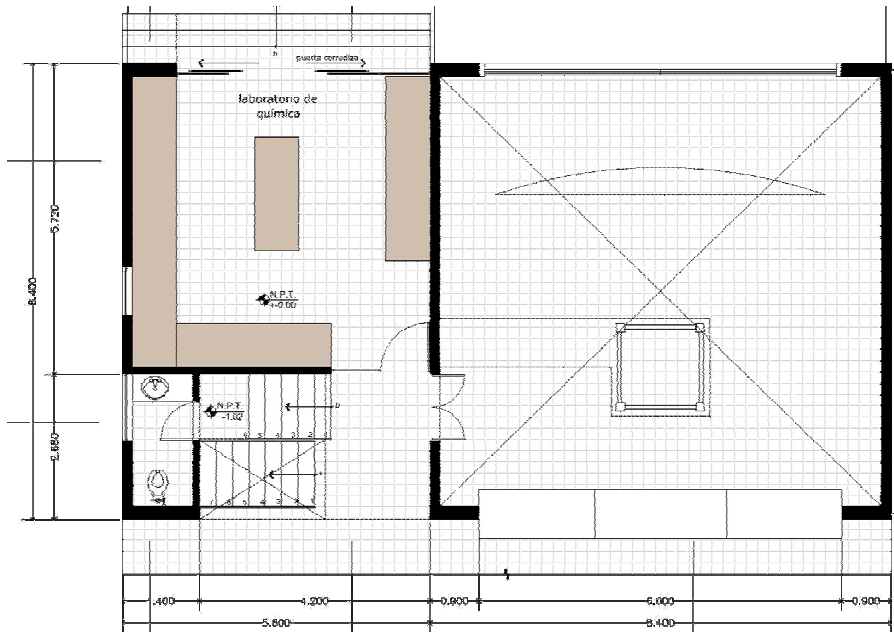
Plano planta baja, laboratorio de química solar y base de la estructura del concentrador.
